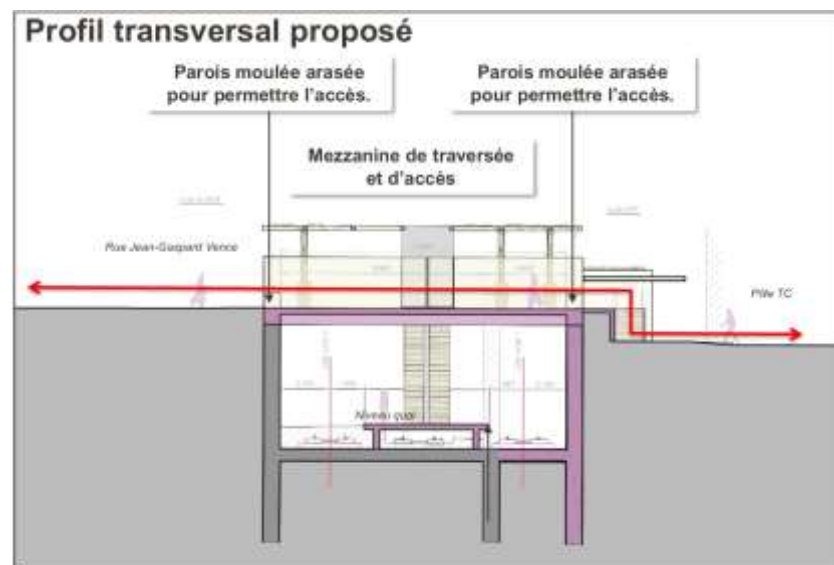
Profil en travers de la halte d'Arenc. La nouvelle paroi est figurée en violet (AREP, 2021)
